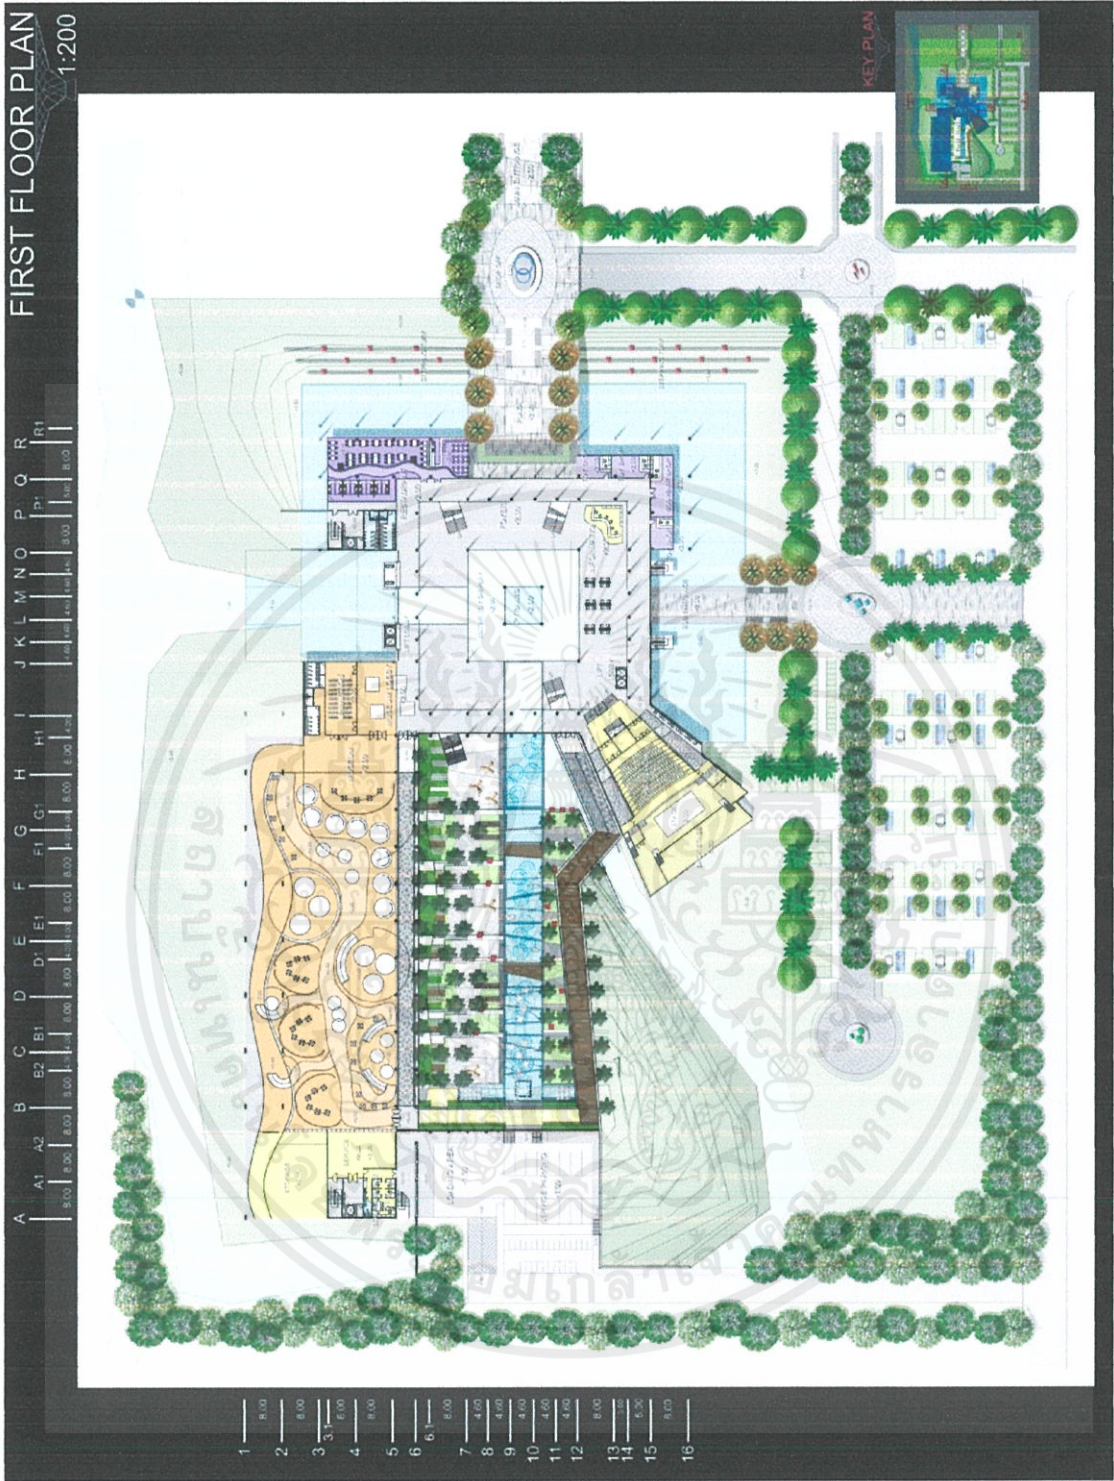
8 ผลงานการออกแบบ LAYOUT PLAN , LANDSCAPE PLAN ,
